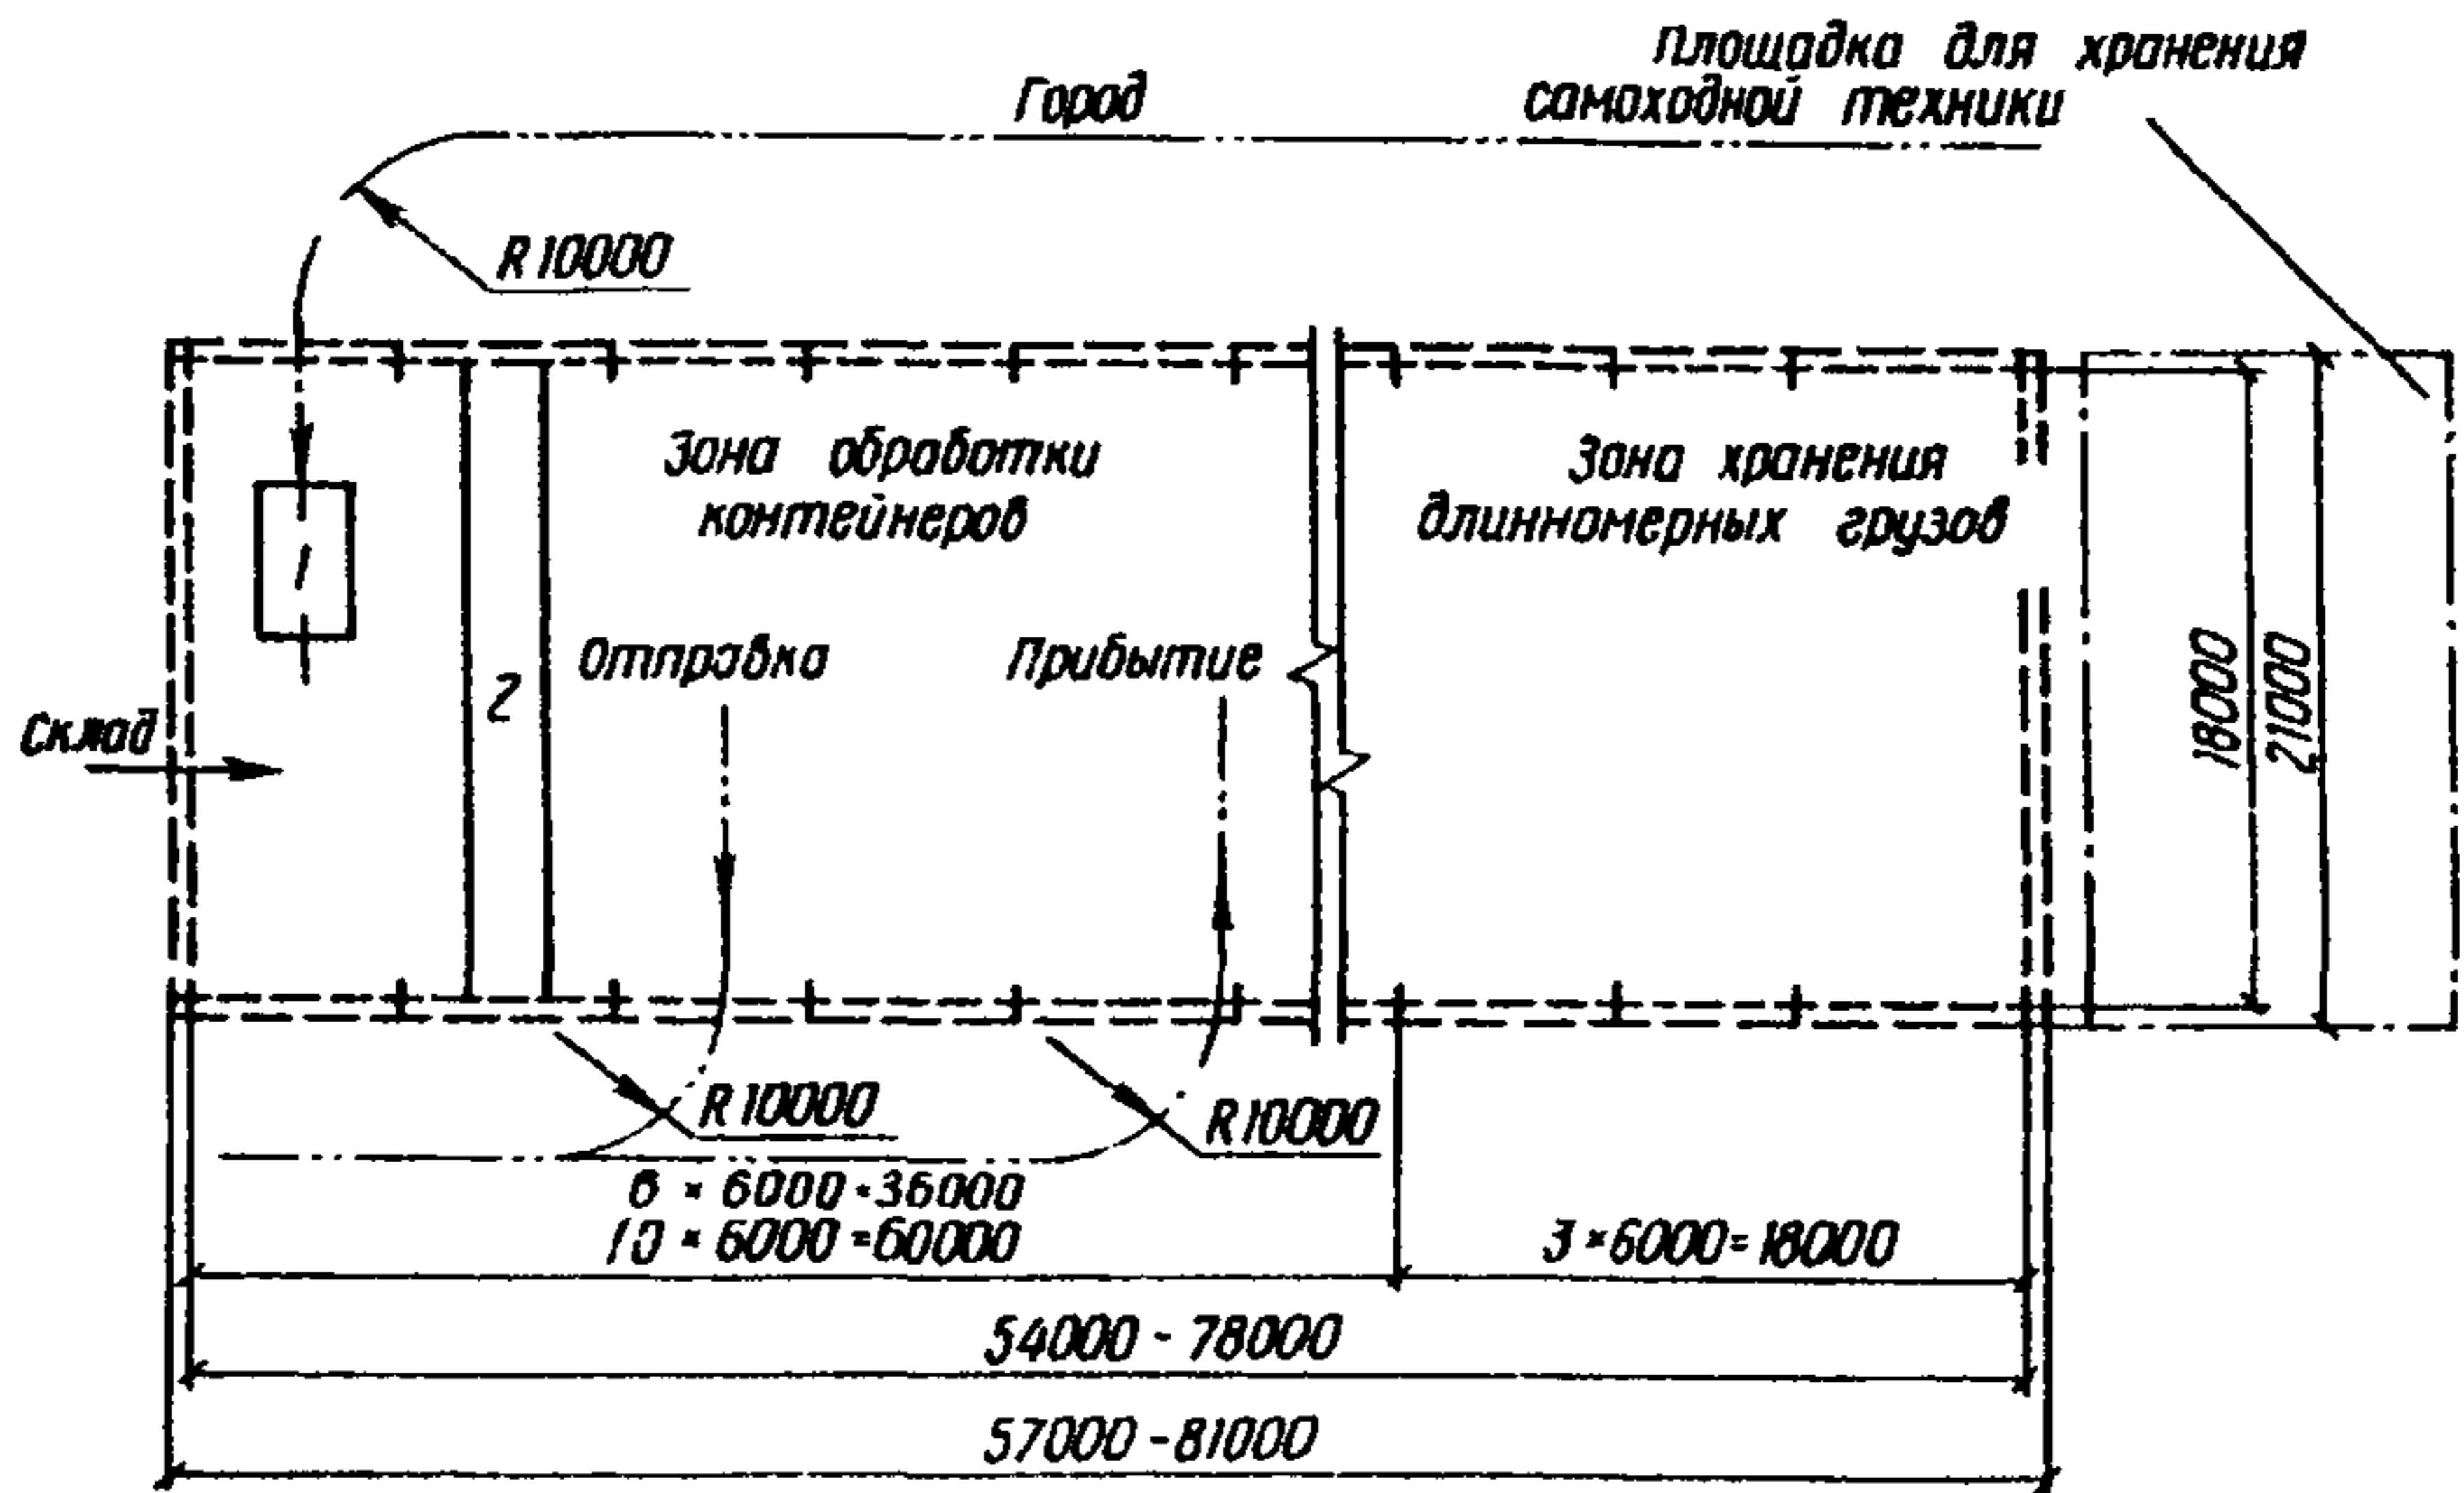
Схема размещения оборудования на контейнерной площадке с грузооборотом до 120 т/сут. (для аэропортов Крайнего Севера):
